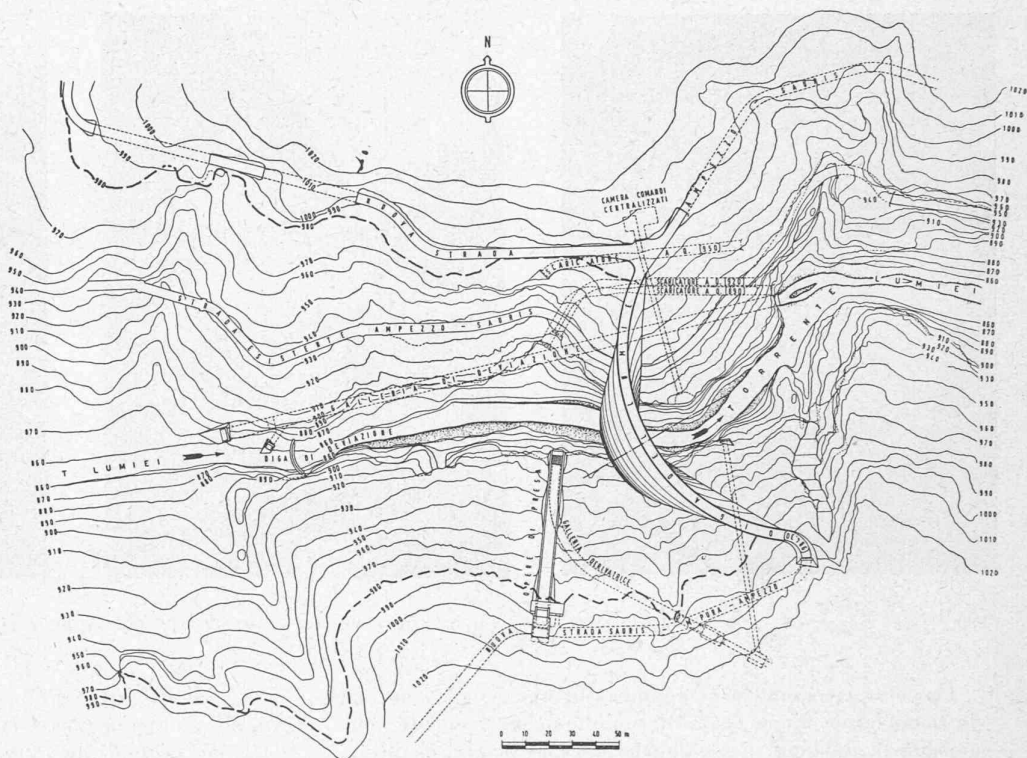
Barrage du Lumiei. — Plan de situation.
